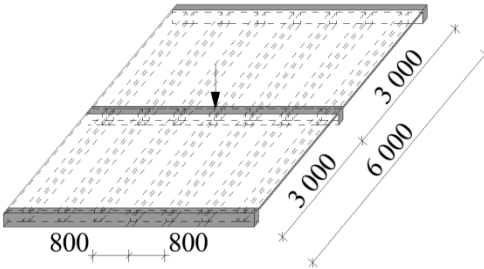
Схема поперечного сечения фрагмента часторебристого перекрытия
